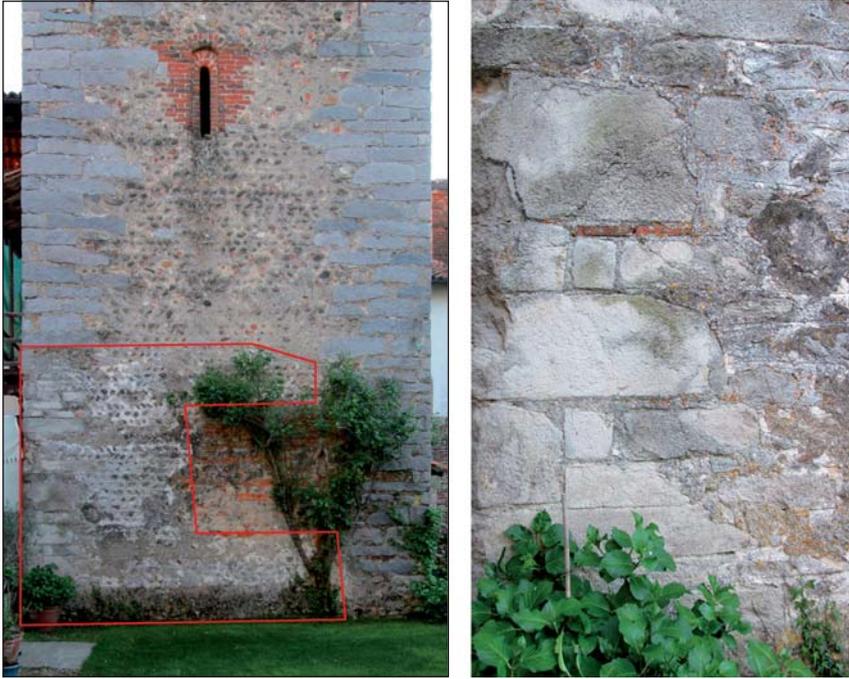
Massazza. 10.a. Il prospetto Nord-Est della parte basale della torre; in evidenza la porzione di muratura più antica; 10.b. Dettaglio del cantonale Est (foto G. Ardizio).
